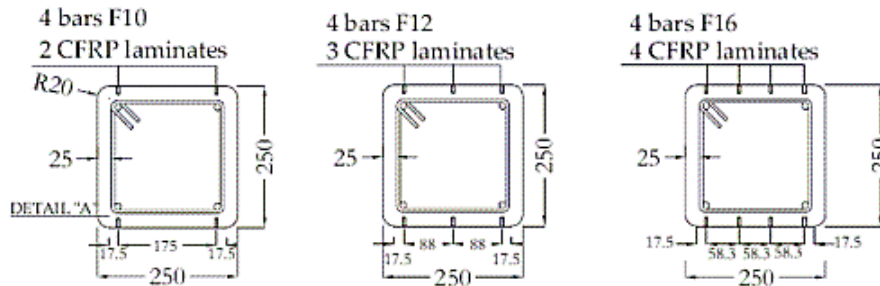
Détails de la disposition des plats PRFC et du taux d'aciers longitudinaux (Perrone et al., 2009).
